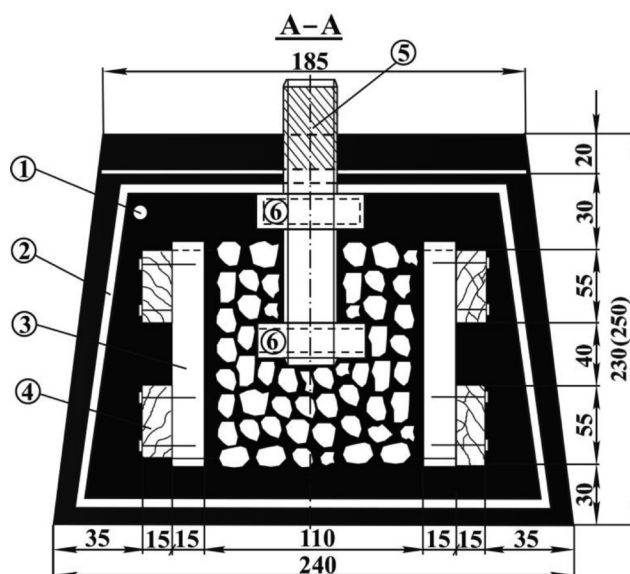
Поперечное сечение бруса стрелочных переводов из каркасного древесного стекловолоконного КМ. 1 – полимерная матрица, армированная щепой; 2 – три слоя стеклосетки; 3 – прокладки из древесины, прибиваемые под углом $60...70^\circ$; 4 – доски каркаса из тонкомера, горбыля и т.п., соединяемые на гвоздях; 5 – болт крепления рельс, замоноличенный в объеме изделия; 6 – гайки
